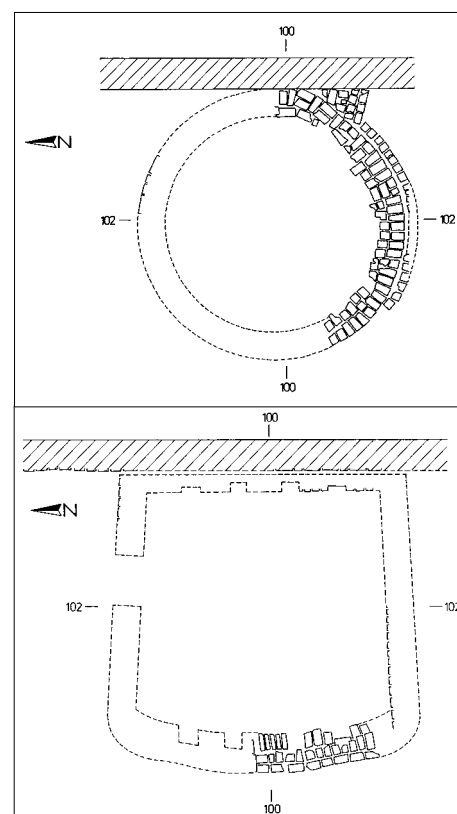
Engelswisch 65; oben: Grundriss des mittelalterlichen Backofens; unten: Grundriss des frühneuzeitlichen Backofens (nach Gläser 1989).
